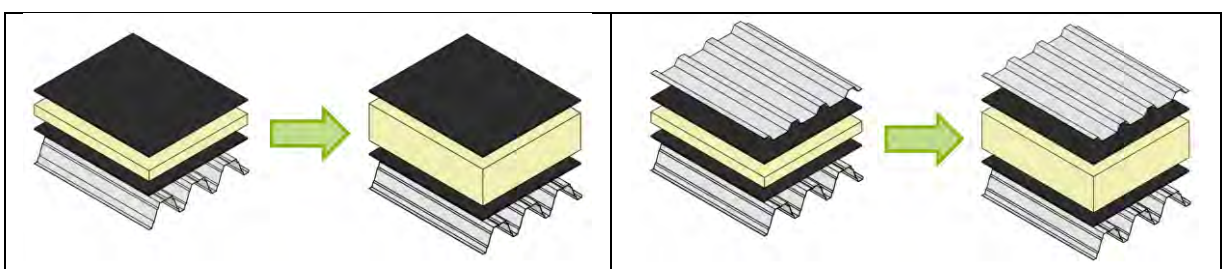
Skizze: Erweiterung der Dämmung einschaliges Trapezdach
